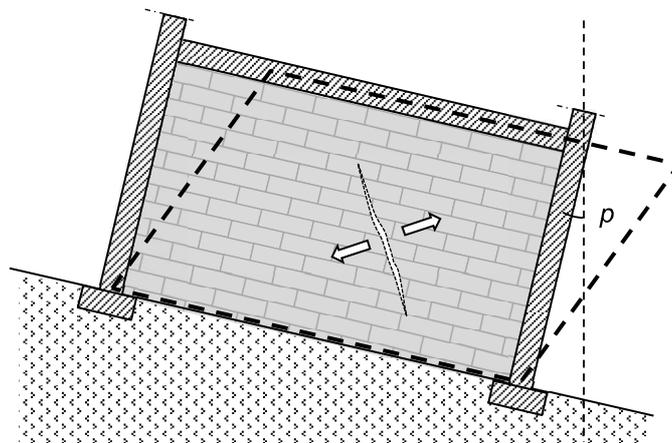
Exemple de fissures diagonales induites par la mise en parallélogramme du mur de remplissage en cas de mise en pente du terrain
